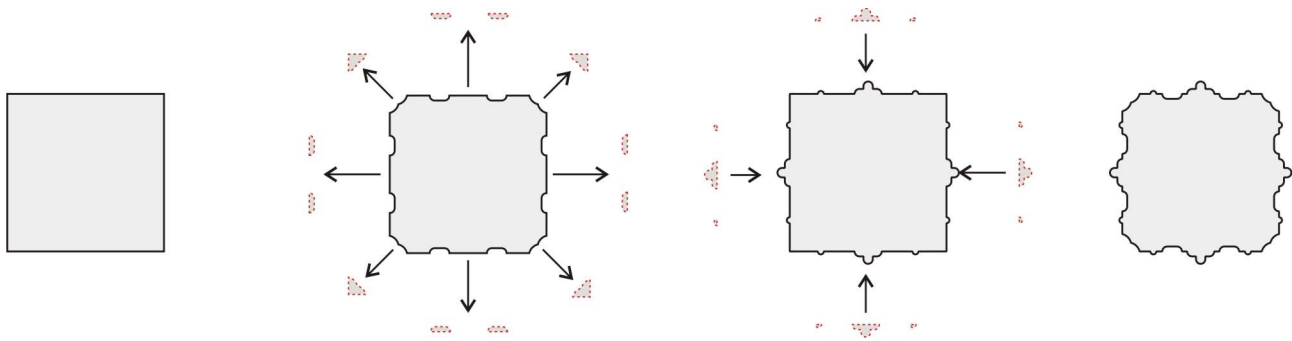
San Francisco: Claustro de San Buenaventura. Entwicklung des Pfeilergrundrisses im Obergeschoss. Eigene Zeichnung, 2006.
